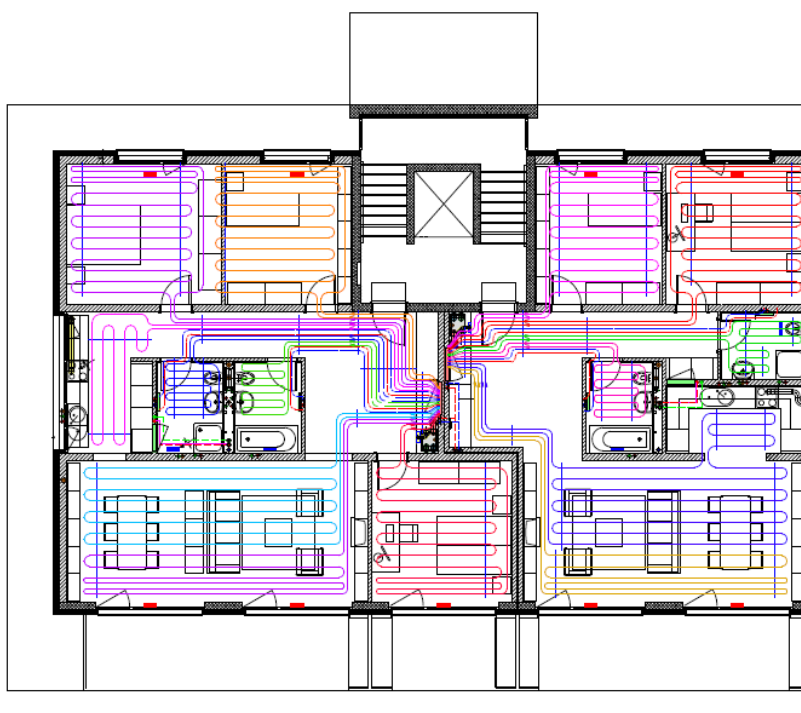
Pianta del terzo piano indicante la disposizione dei TABS
